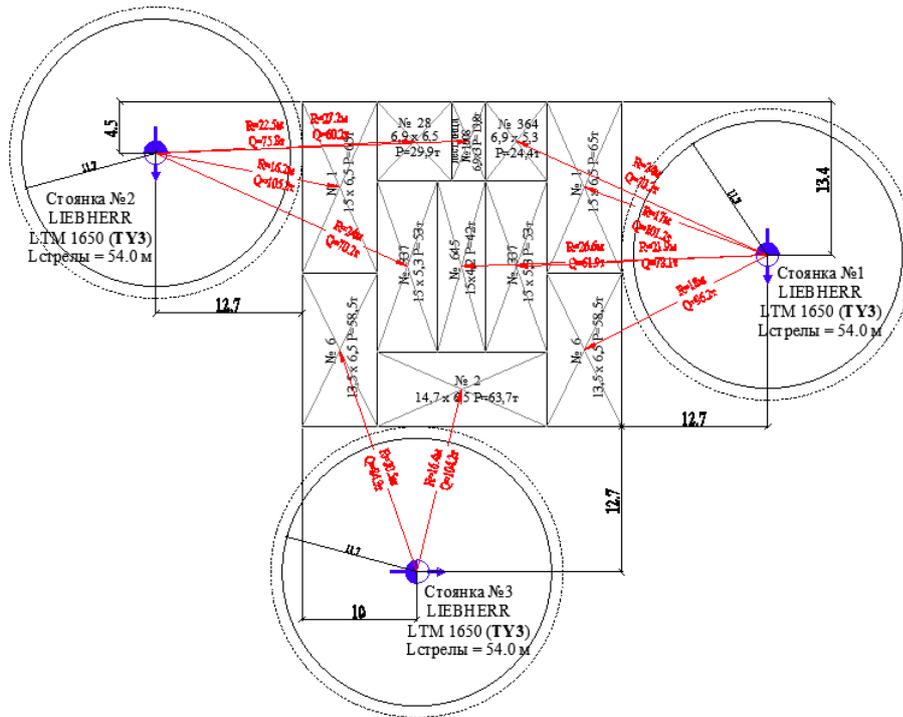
Схема имитационного моделирования механизации монтажных работ мобильным краном на спецшасси для монтажа жилого здания «Башня» «Тип 1». План.
